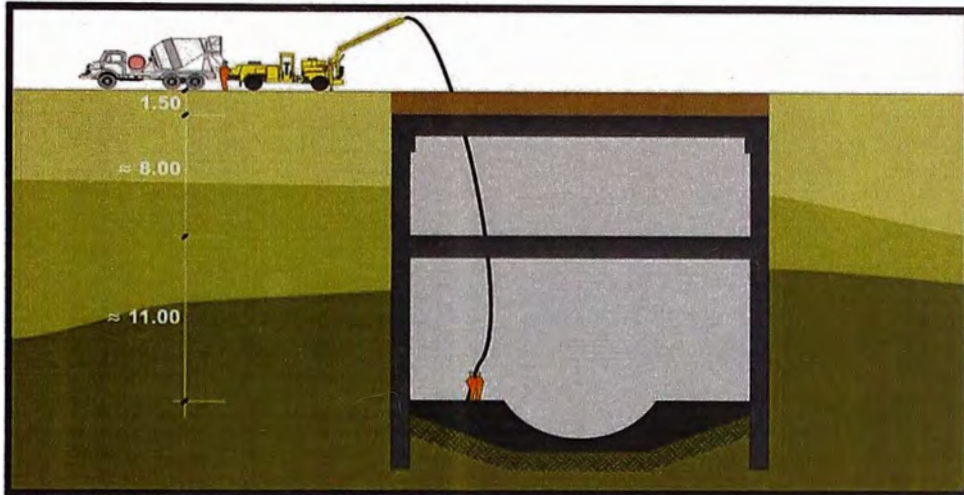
Esquema del Vaciado de la losa de fondo con bomba de concreto estática.
